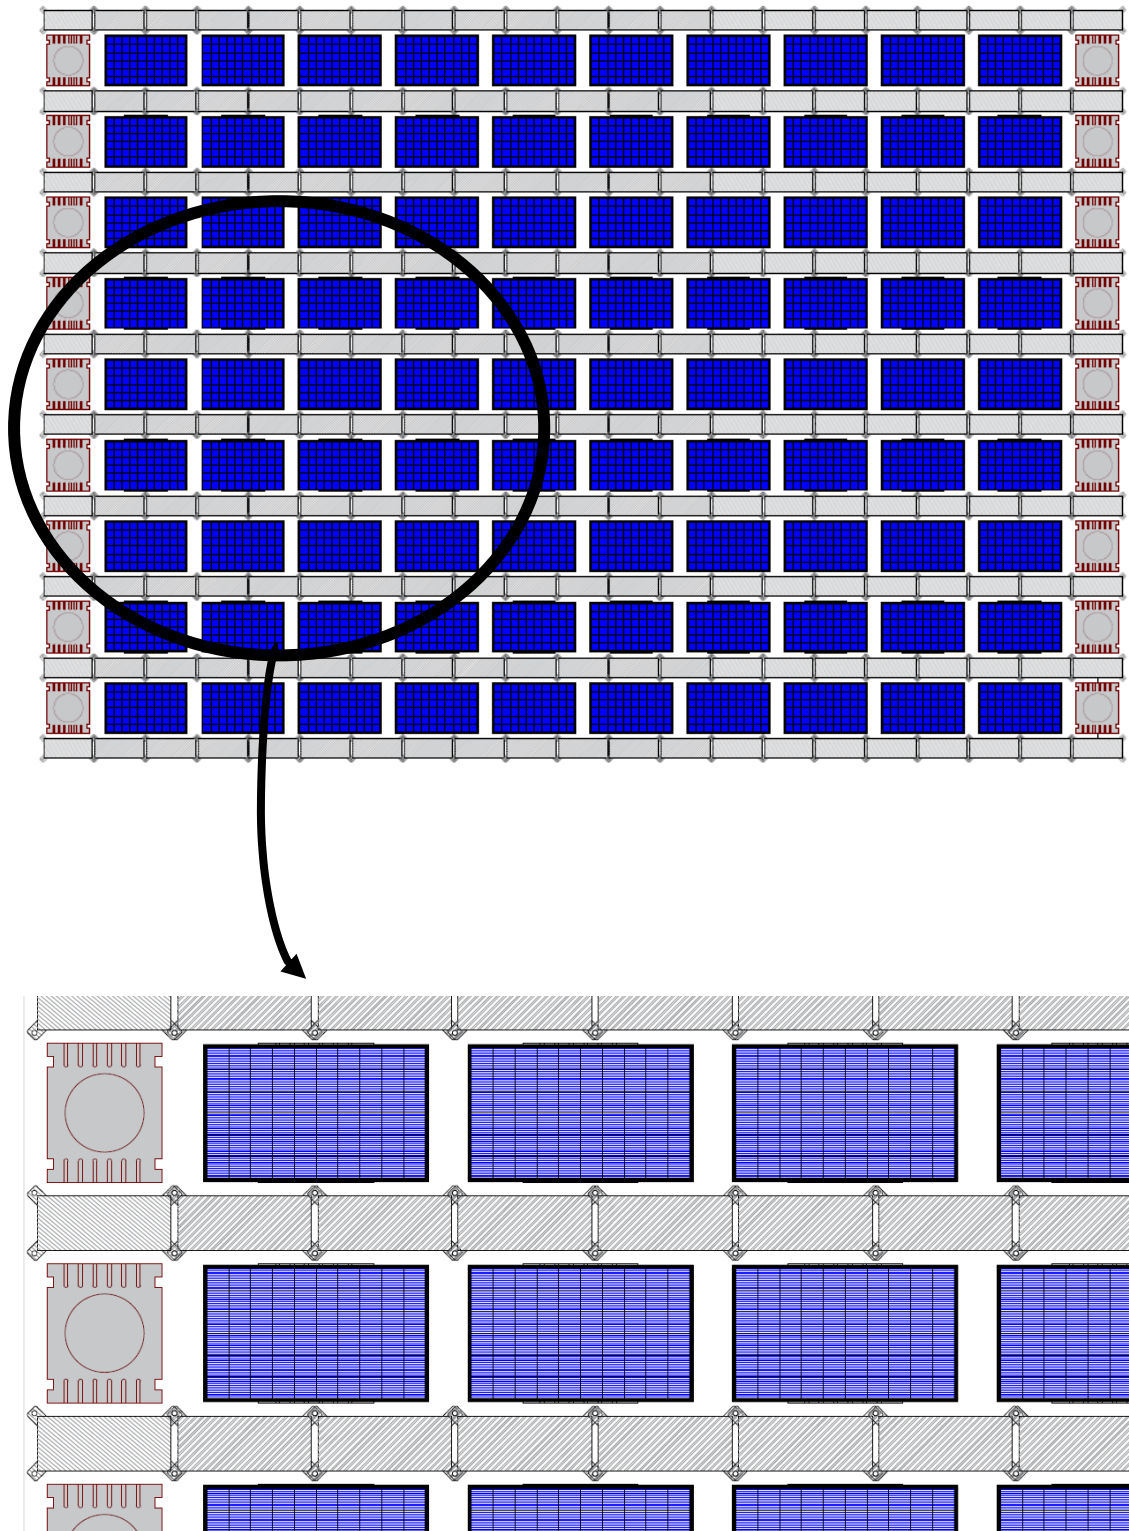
Modelado 2D de la planta solar flotante (AUTOCAD)
